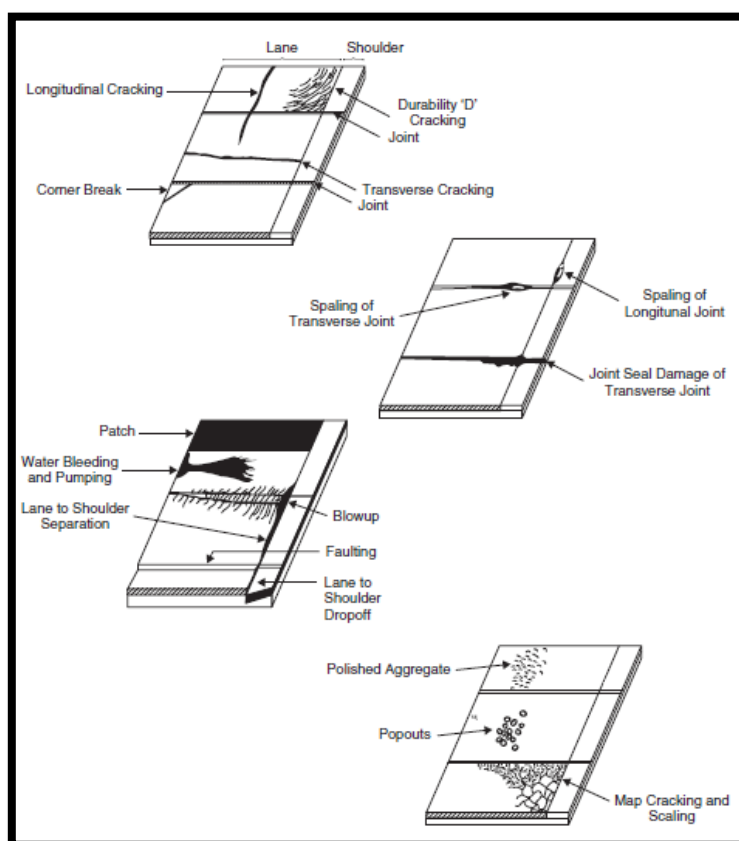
Deterioros en pavimentos de hormigón portland. (SHRP, 1993).
